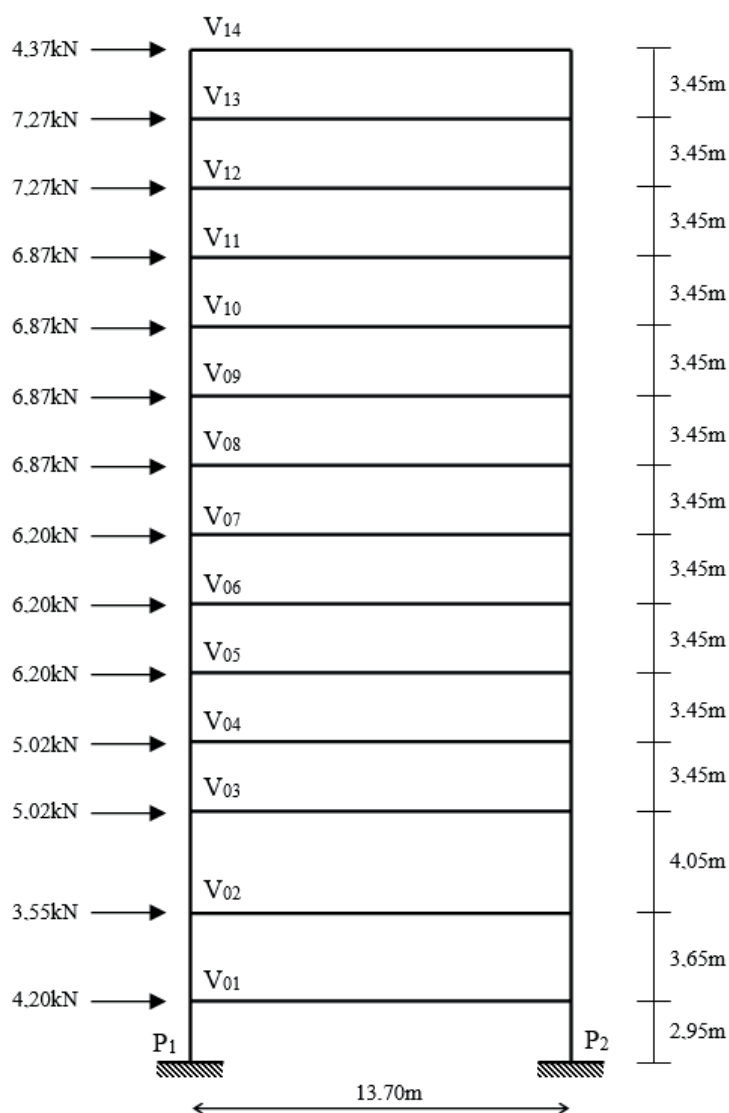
Esquema do pórtico plano de 14 andares, BORGES(2009).
